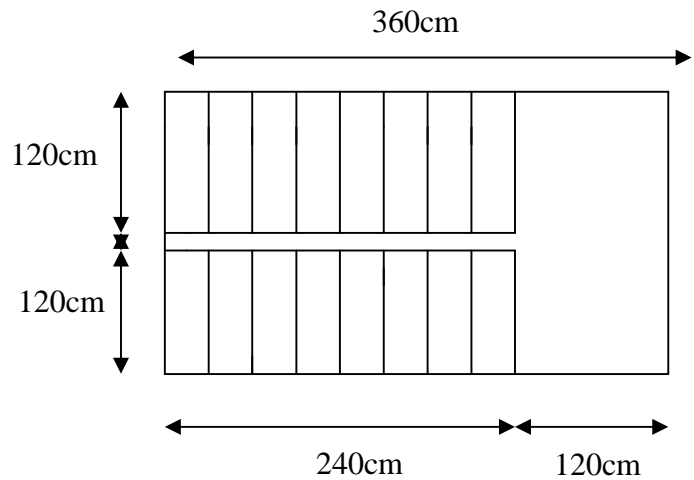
Vue en plan de l'escalier (Type 1)
